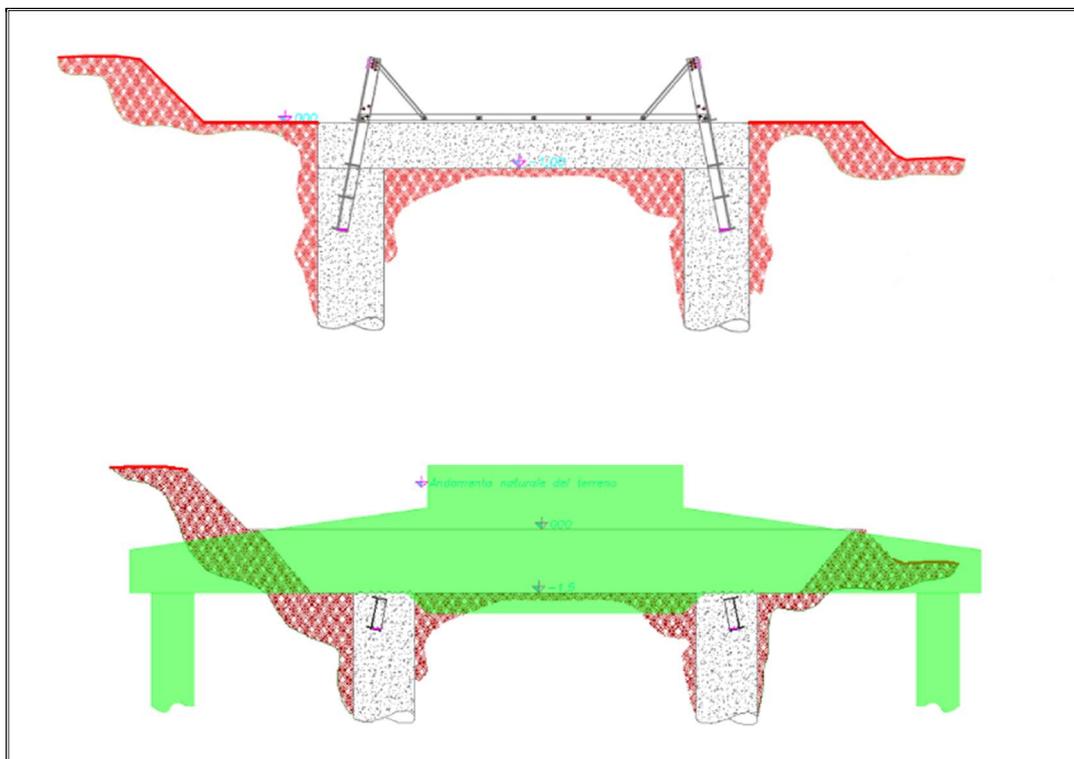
Schema tipico di alloggiamento della nuova fondazione (colore verde) su fondazione esistente e parzialmente demolita (colore grigio).
